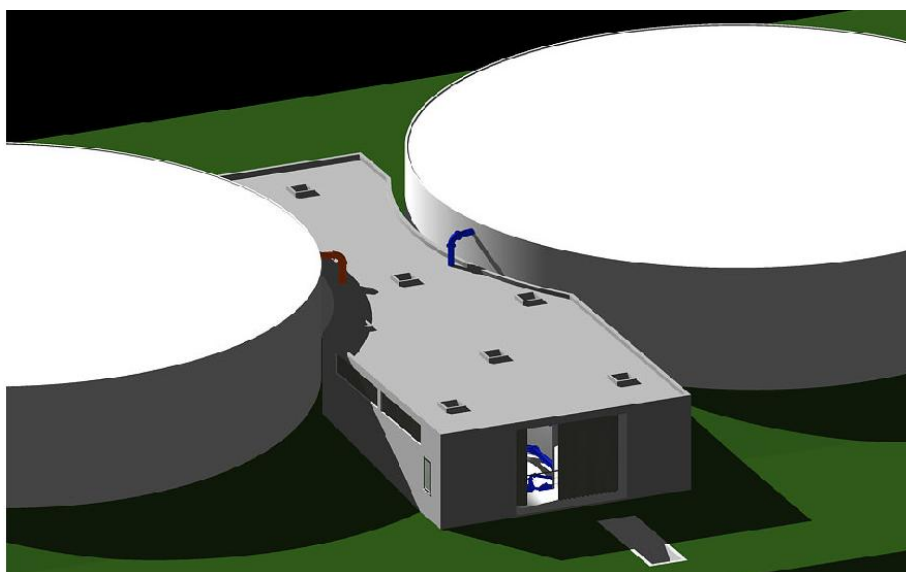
Planta de Cobertura da Câmara de Manobras
